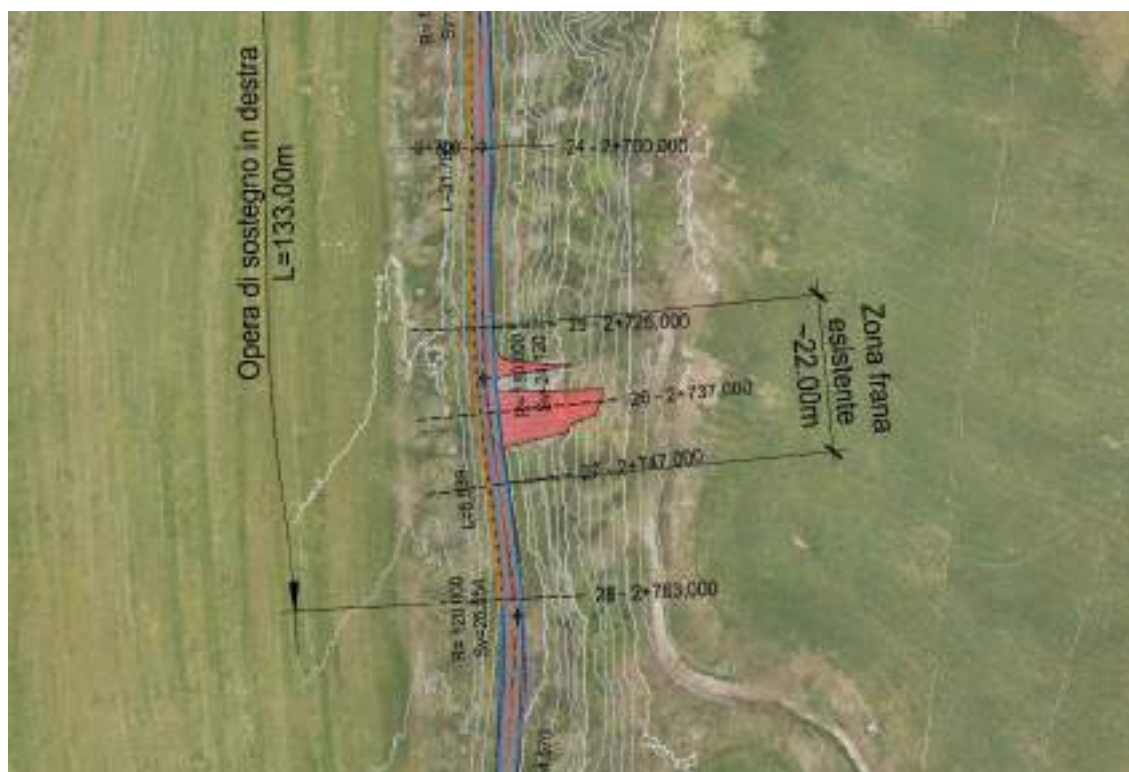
Stralcio planimetrico del progetto in adiacenza alla frana esistente
